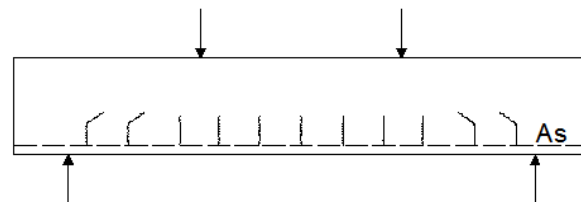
3 Viga fisurada o agrietada.
